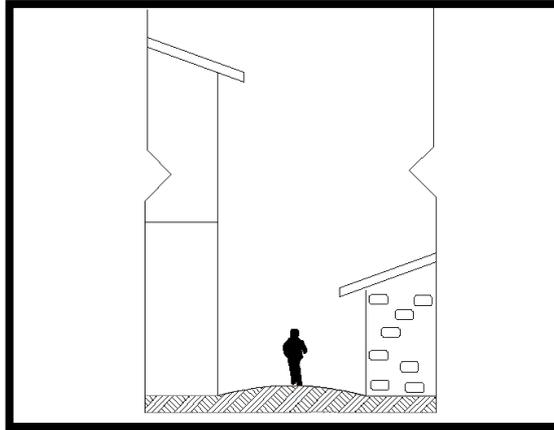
SECCIÓN DE LA CALLE 1 TRAMO (T8 –T9)
